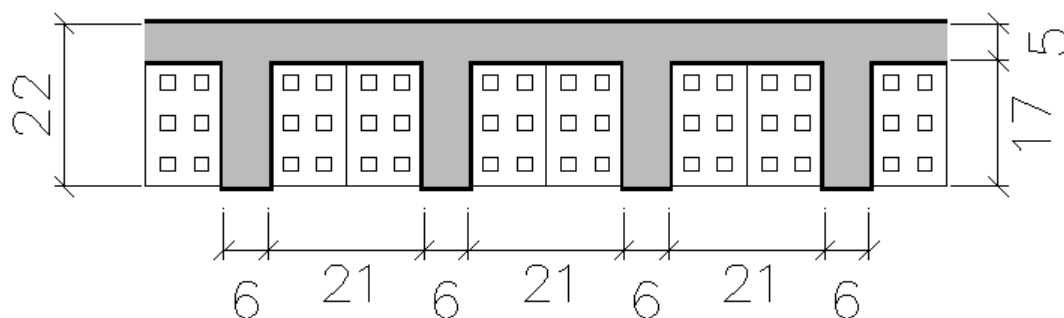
Seção transversal da laje nervurada do piso, com enchimento de tijolos cerâmicos. Concreto  $f_{ck} = 18$  MPa. Armação de  $1\phi 16 + 1\phi 12.5$ , por nervura.
